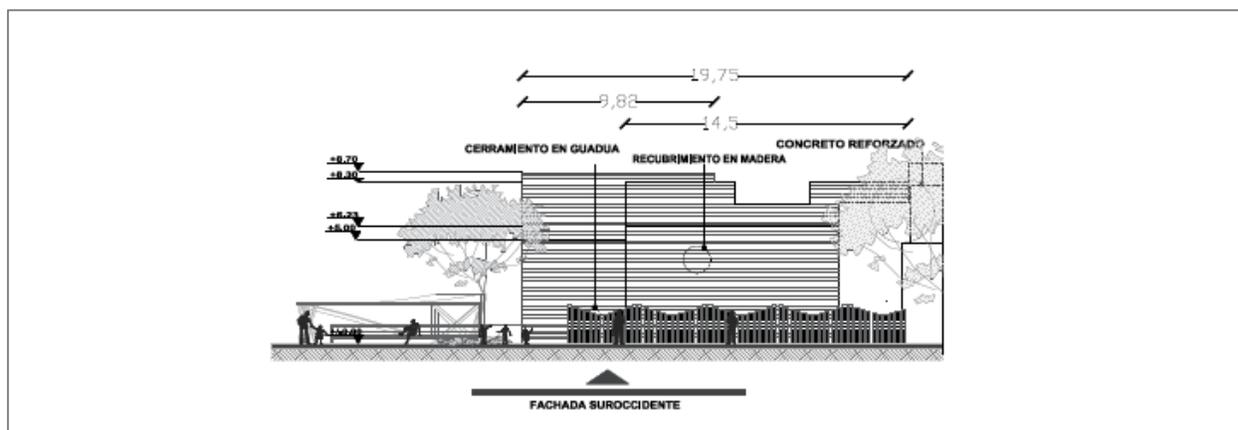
Fachada Suroccidente Edificio 1 (Rubiano, 2020)
